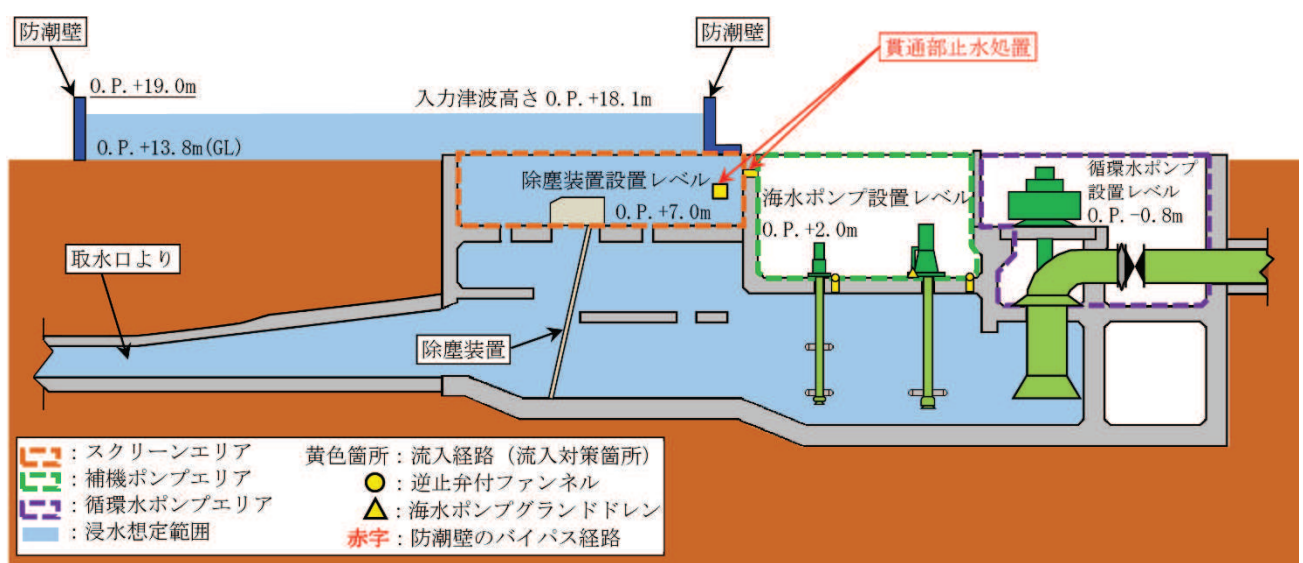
第 2 号機 海水ポンプ室 流入対策配置図 (A-A 断面図)
